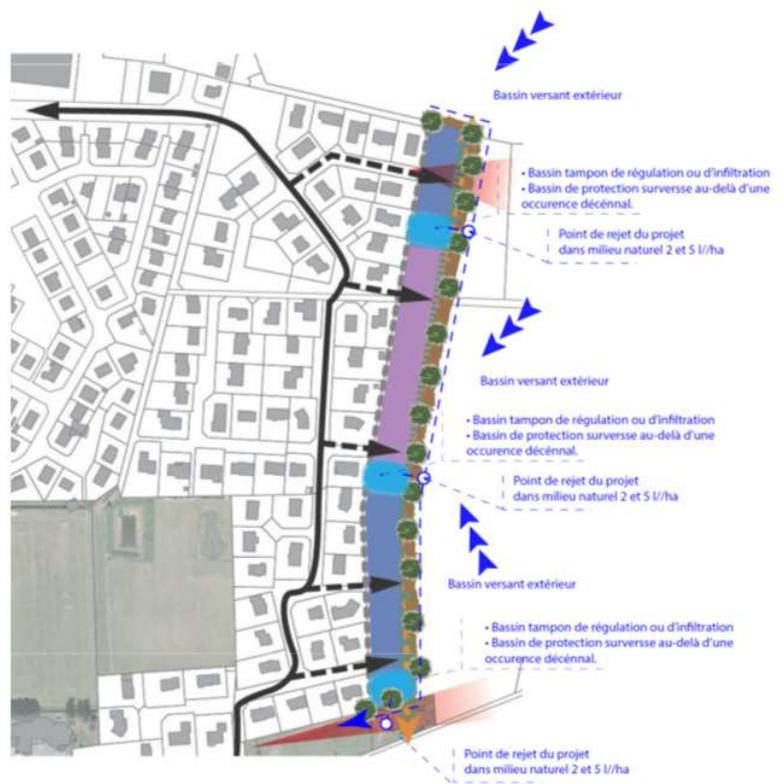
Gestion des eaux pluviales sur le secteur du jardin du stade
